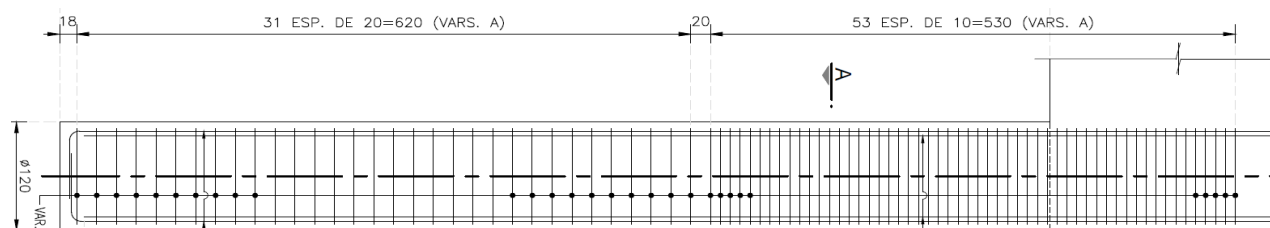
ARI Ingeniería (2023) "Ejemplo detallado del armado de acero transversal de pila de cimentación del Apoyo 13"
